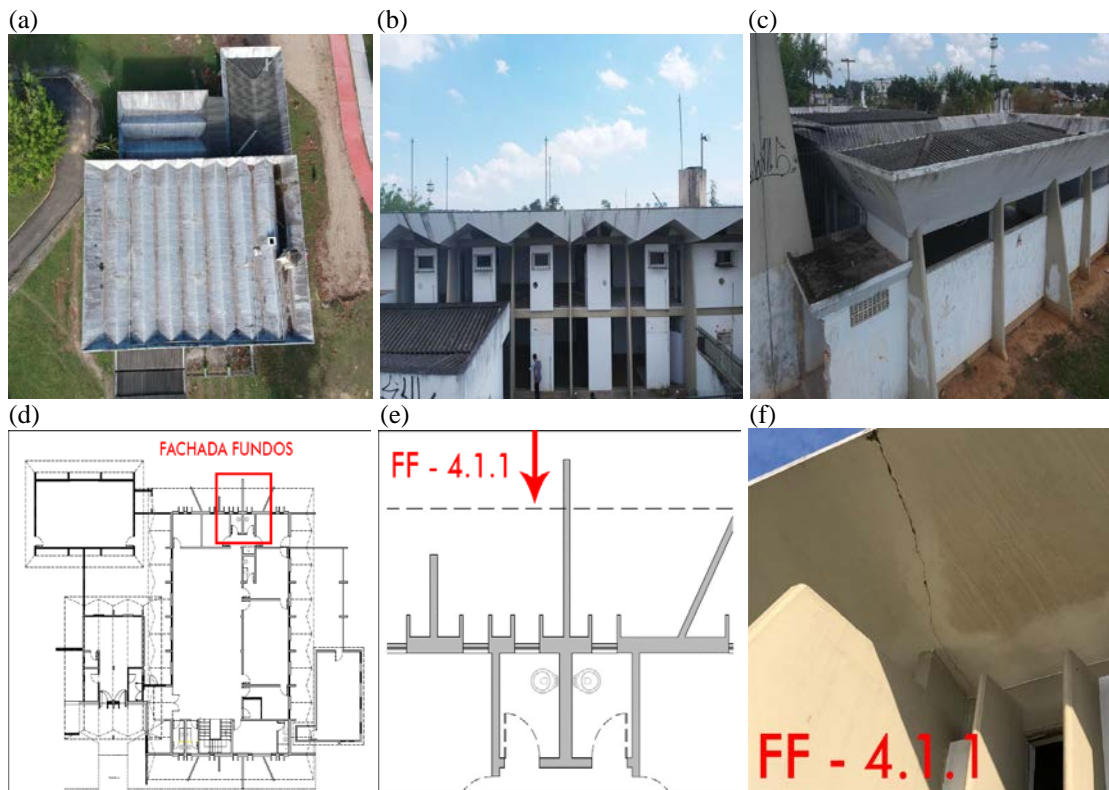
Trinca no beiral: (a) vista superior da edificação, (b) vista da fachada lateral direita, (c) vista de uma parte da fachada fundos, (d) planta baixa do pavimento térreo, (e) planta baixa ampliada indicando onde a manifestação de patologia se encontra, (f) foto da manifestação de patologia
